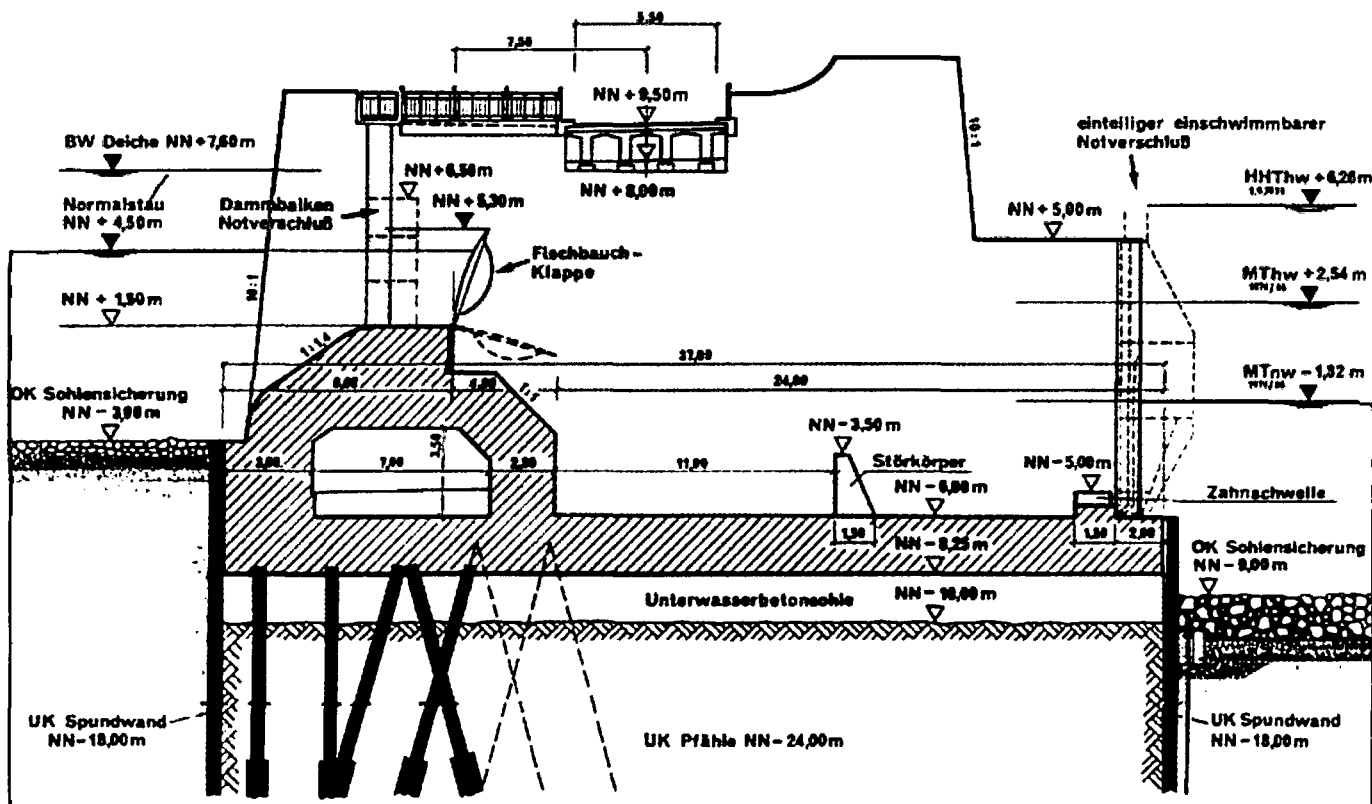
Coupe transversale du barrage mobile de Bremen Weser (Allemagne)
